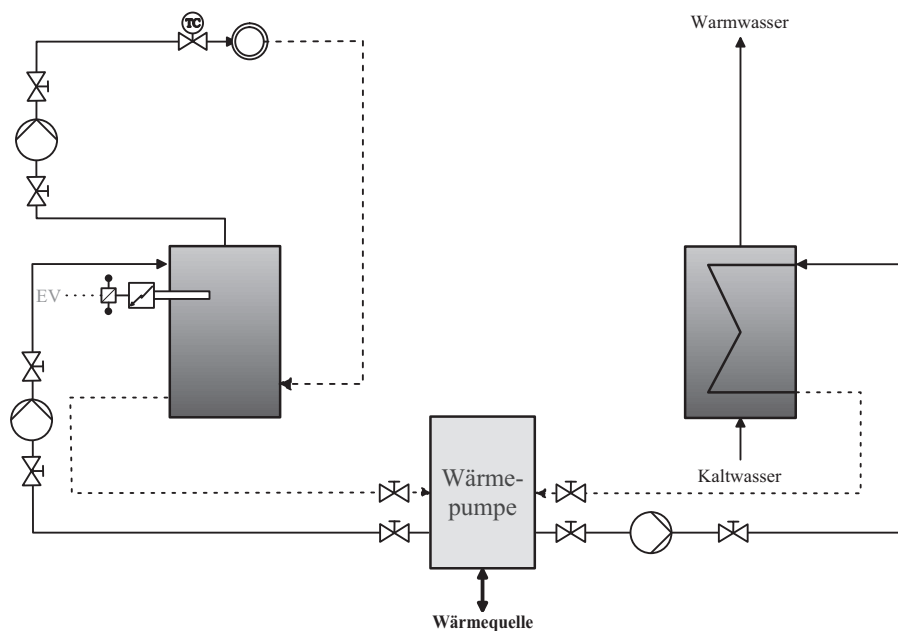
Hydraulische Grundschaltung einer Anlage mit Wärmepumpe inklusive Trinkwarmwasserbereitung
